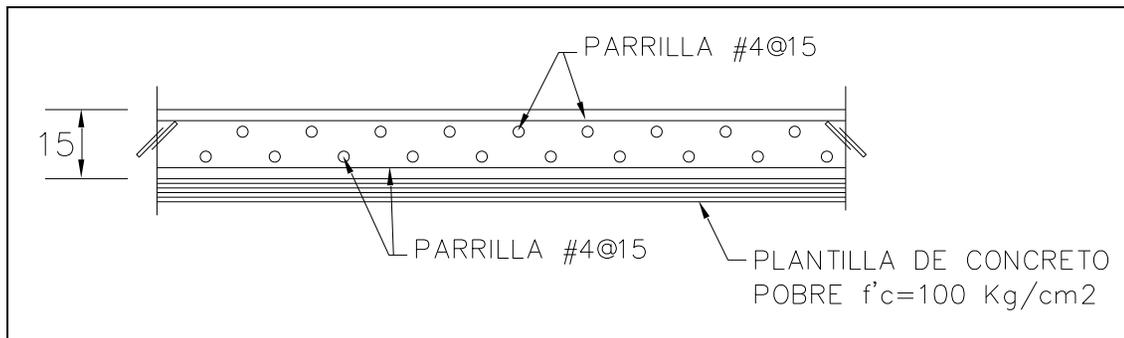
Detalle 2 de losa inferior de zapata.
